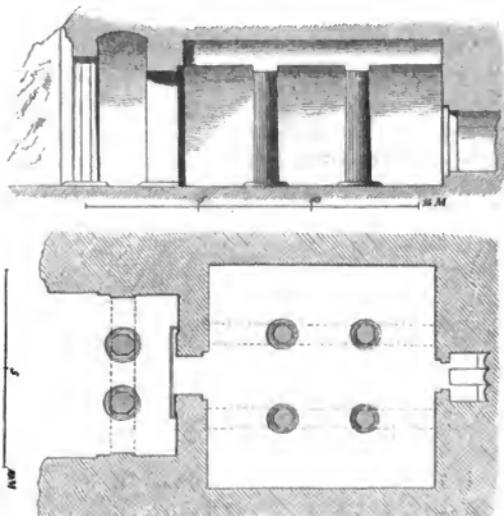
Durchschnitt und Grundriss des nördlichsten Felsengrabes von Beni Hassan.
